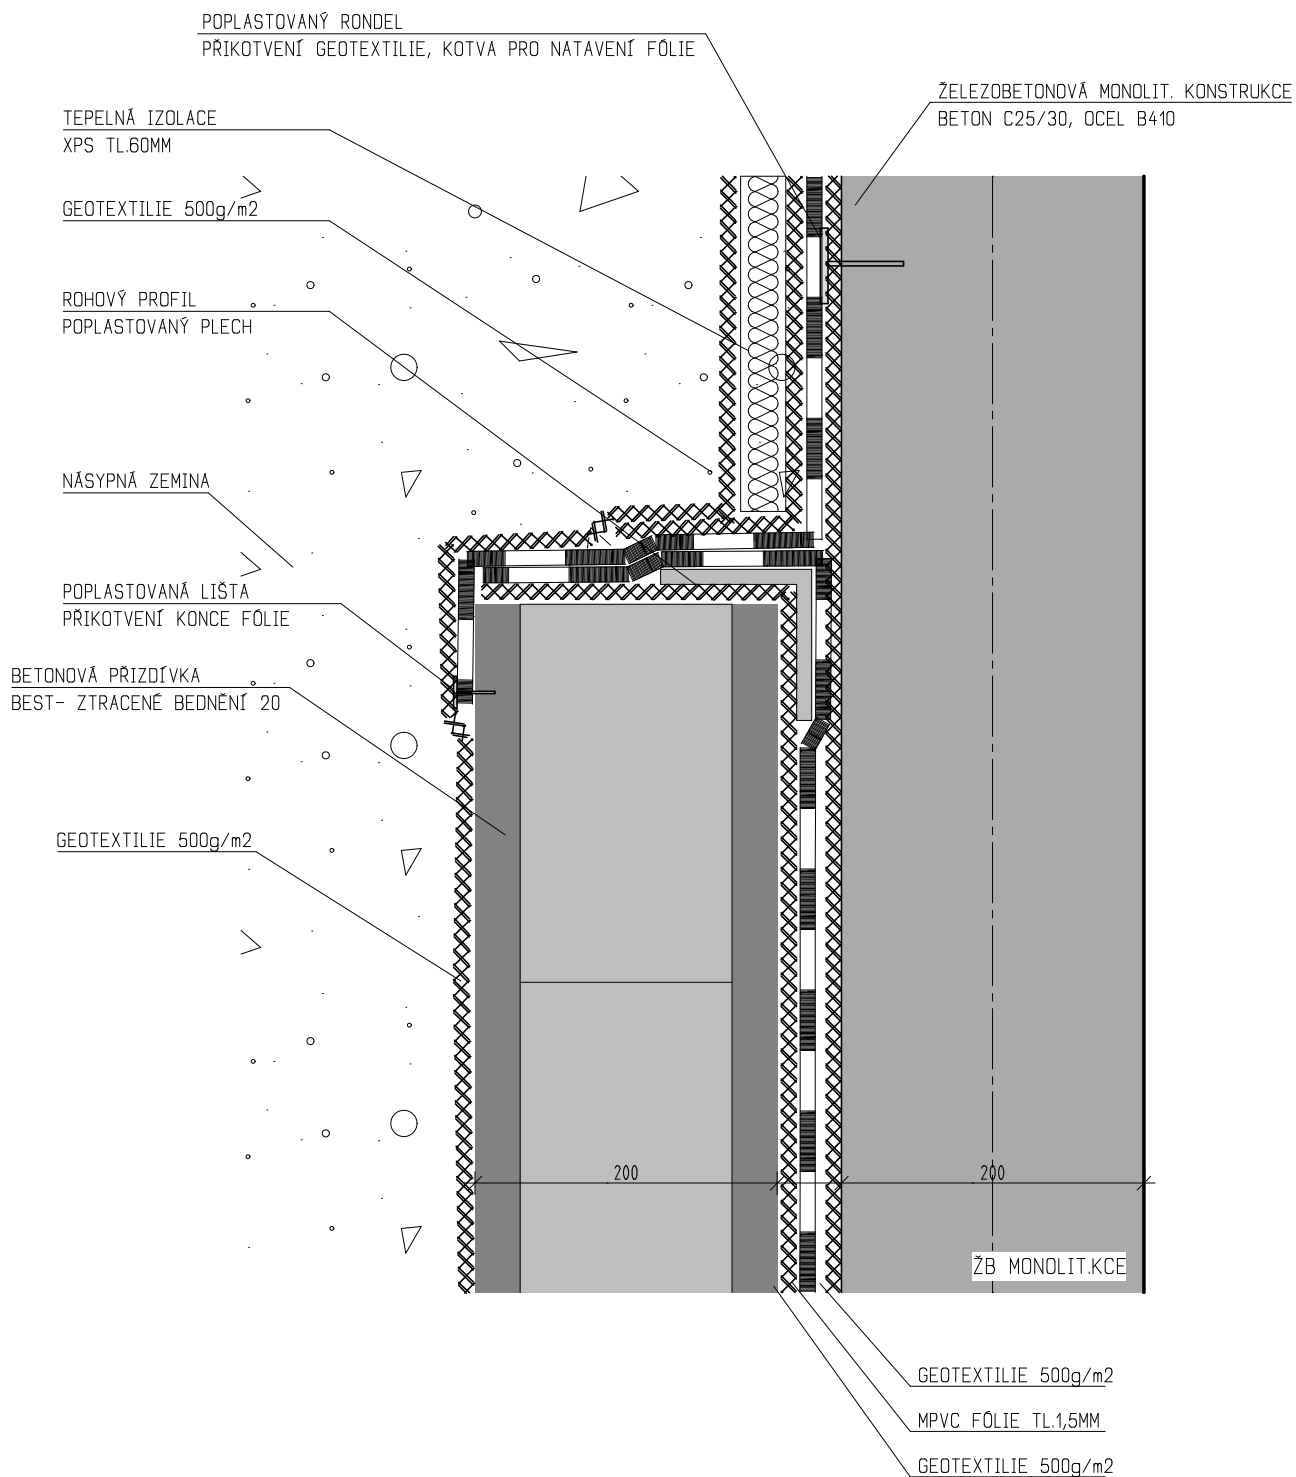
DETAIL HI- MPVC FÓLIE HORNÍ ČÁST
